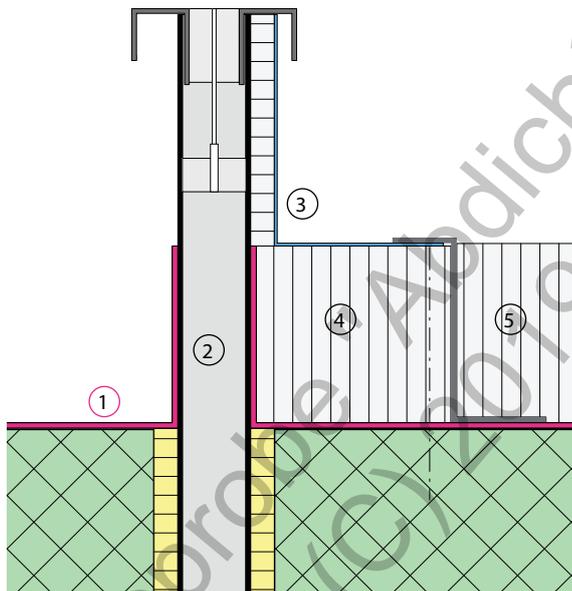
/303 Dampfbremse, Anschluss bei Dunstrohr; Dampfbremse unterlaufsicher auf Untergrund aufgeklebt (1), Dunstrohr (2), Dunstrohreifassung gedämmt (3) über Wärmedämmung (4), Wärmedämmung Fläche (5)
